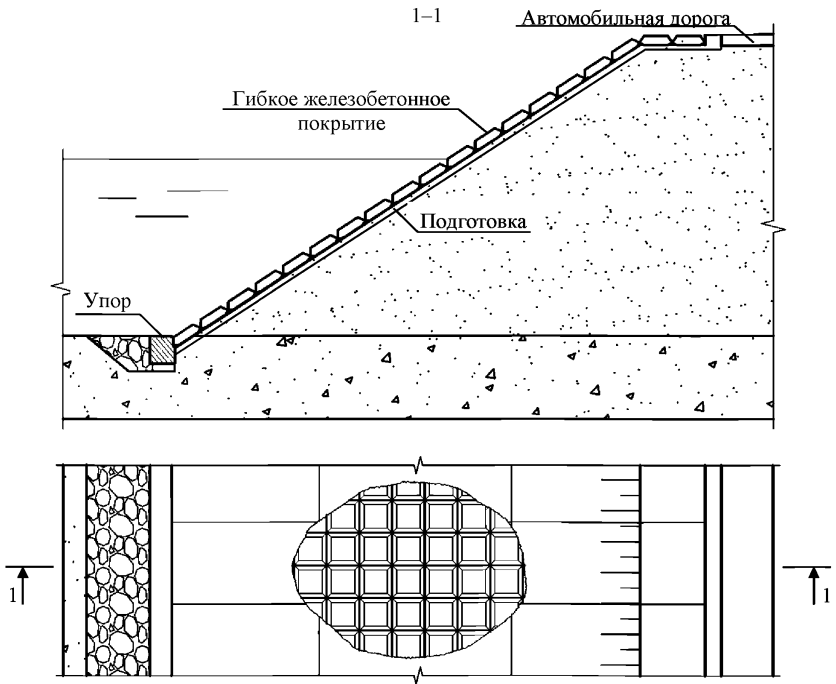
Конструкция откосного сооружения из гибкого железобетонного покрытия
